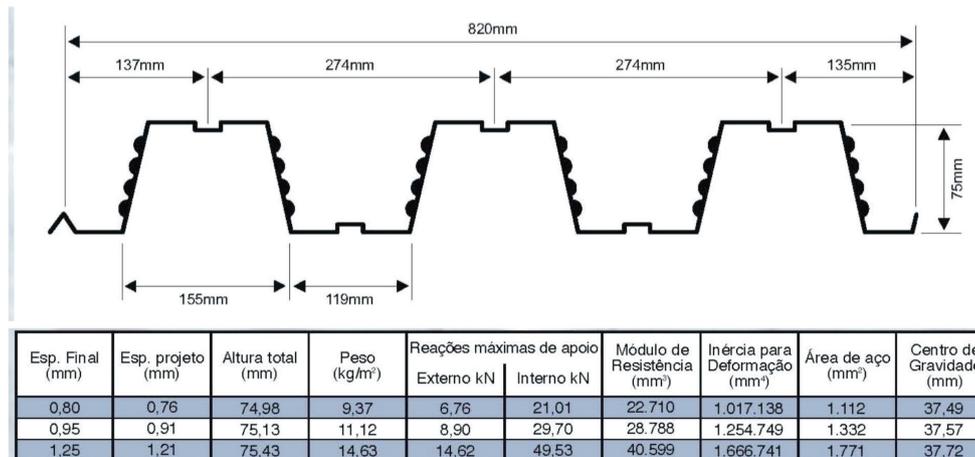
Dados técnicos do fabricante – laje mista steel deck.
